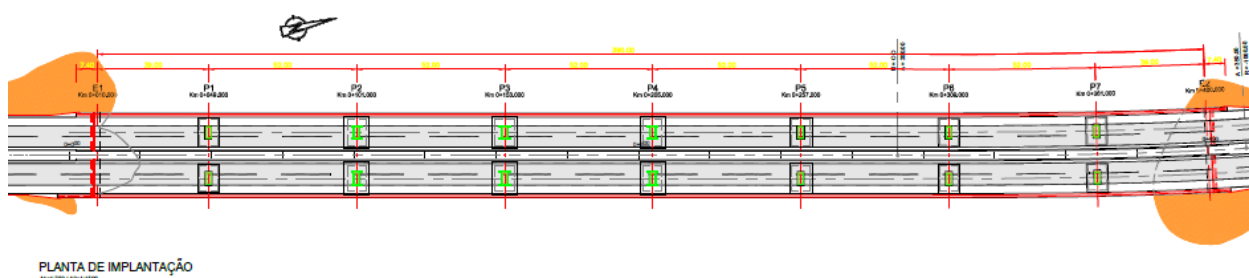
Projeto do Viaduto do Vale do Inferno - planta
